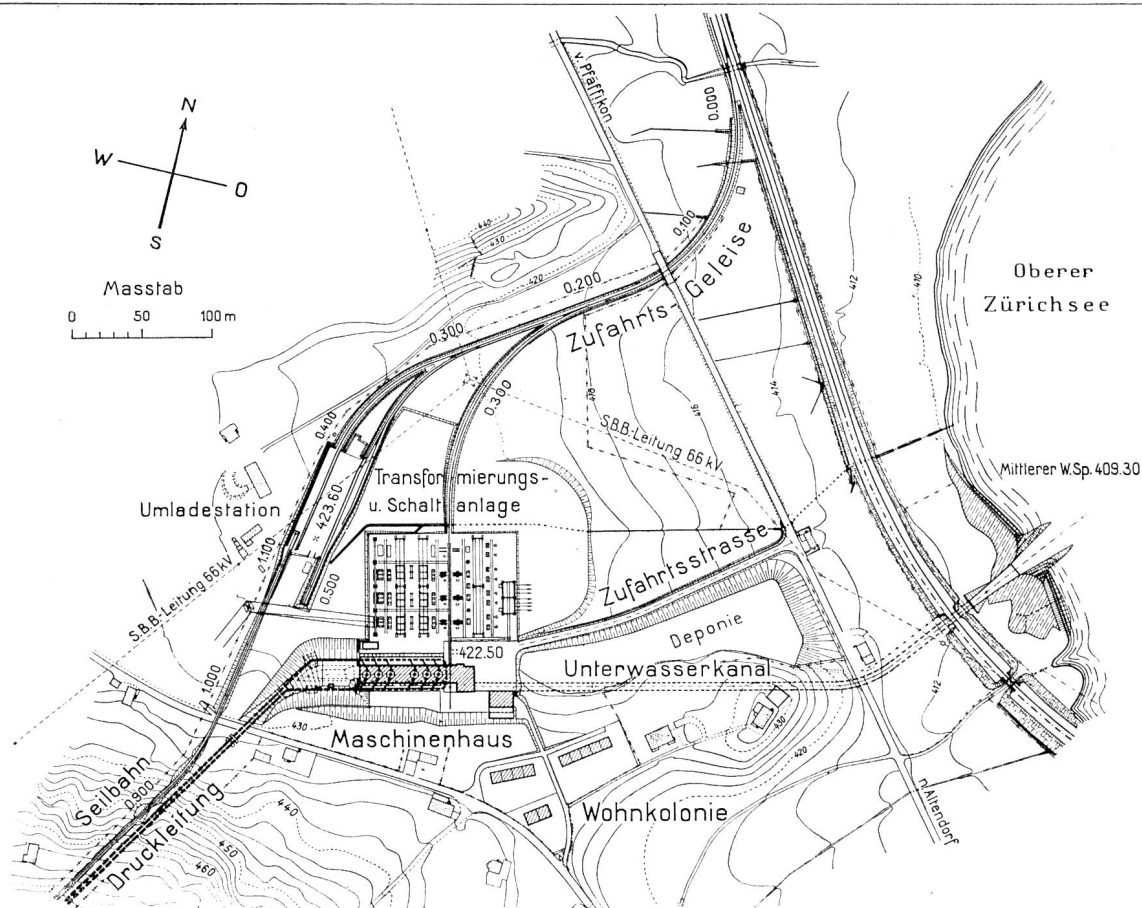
Etzelwerk Lageplan des Maschinenhauses. Maßstab 1:5500 R.P.N: 376.86
